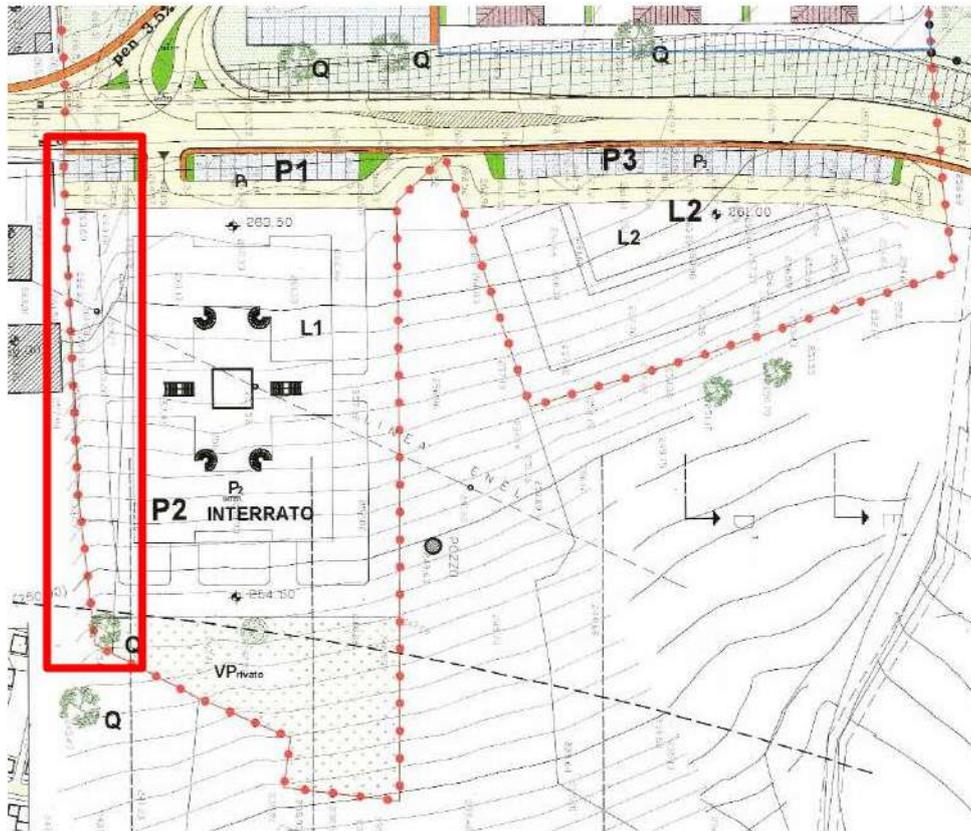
stralcio tavola 2A variante lottizzazione part. 1342-1343-1345-1346
